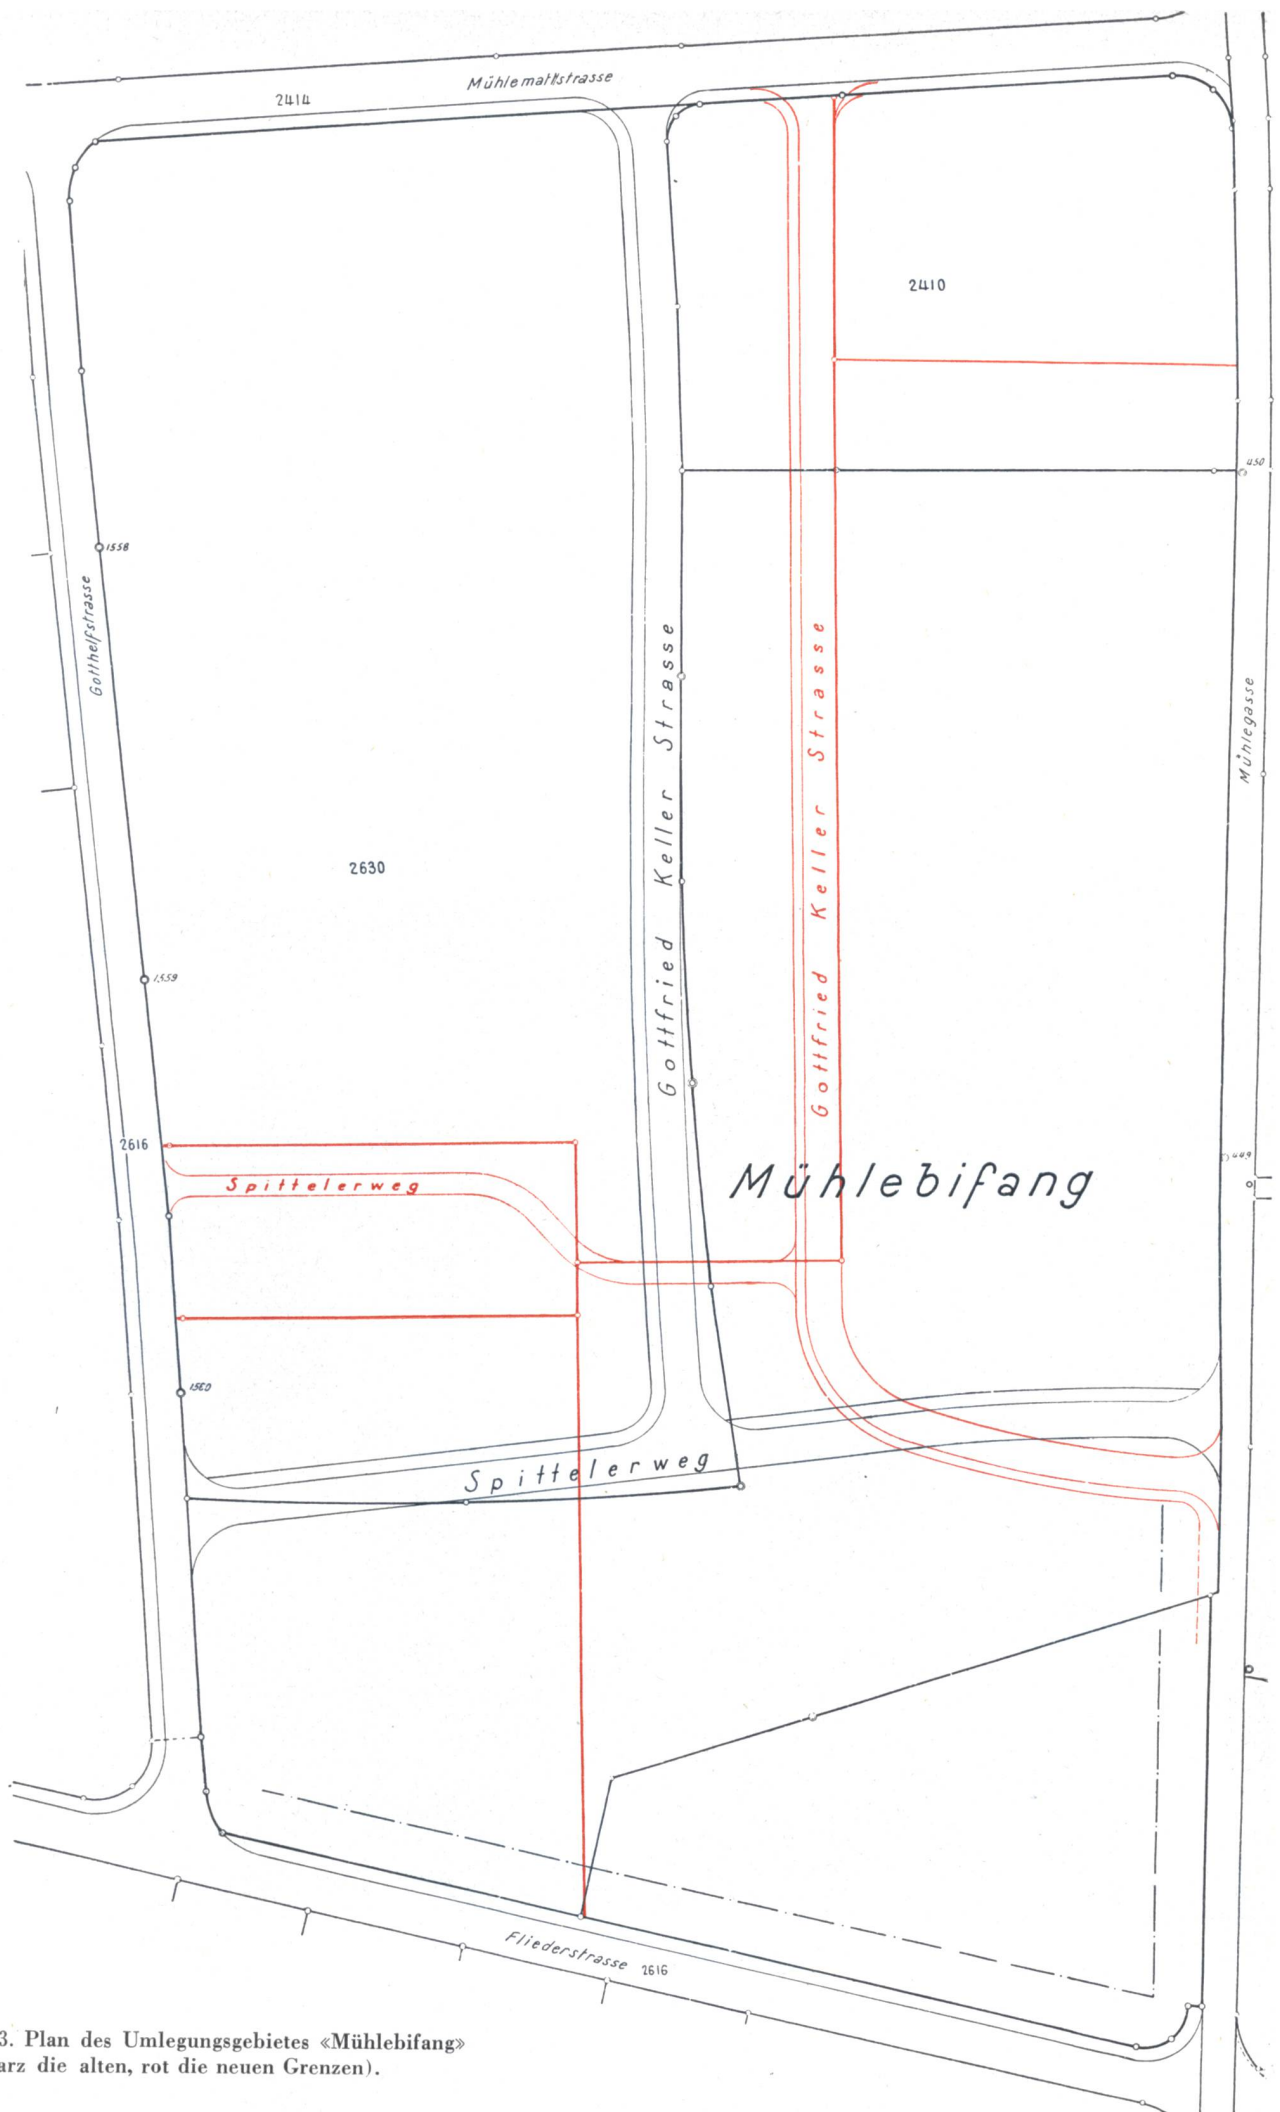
Plan des Umlegungsgebietes «Mühlebifang»
